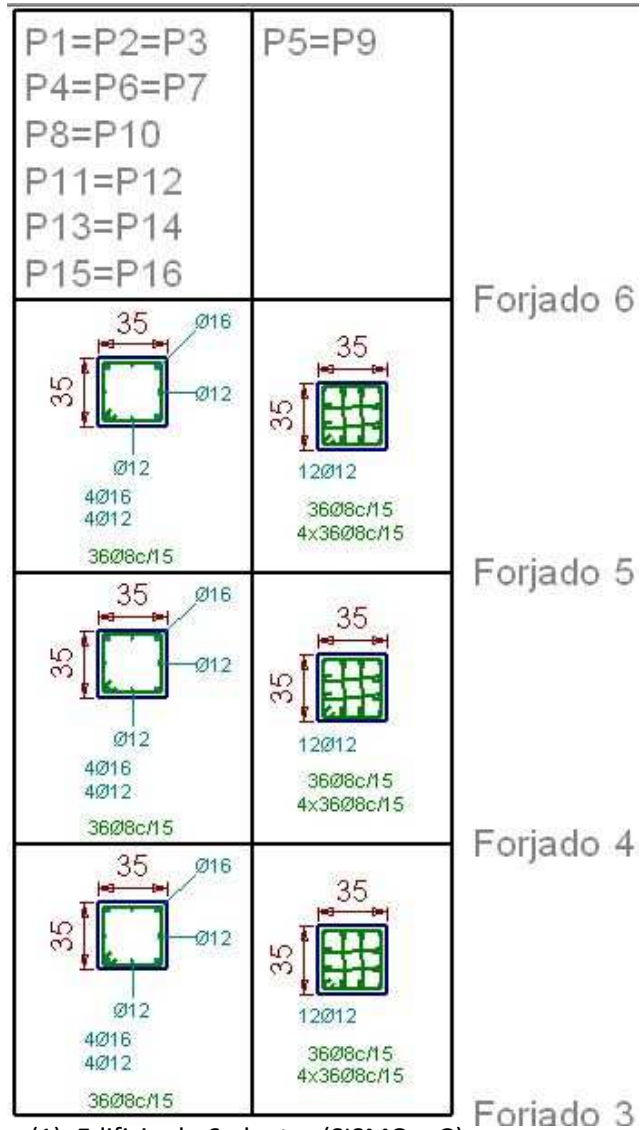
Armadura en pilares (1). Edificio de 6 plantas (SISMO + G).
